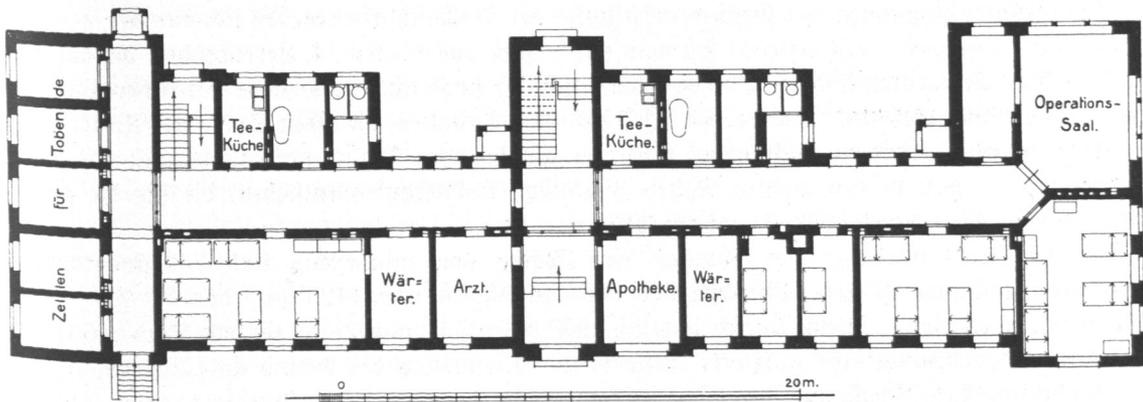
2. Gefängnis Fuhlsbüttel am Hasenberge, Lazarettgebäude, Grundriß, Erdgeschoß.
